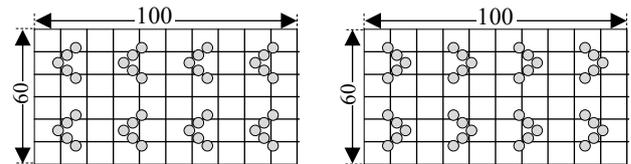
魚道側面図 (左) および粗度群 (右) 概要図 (単位: cm)
